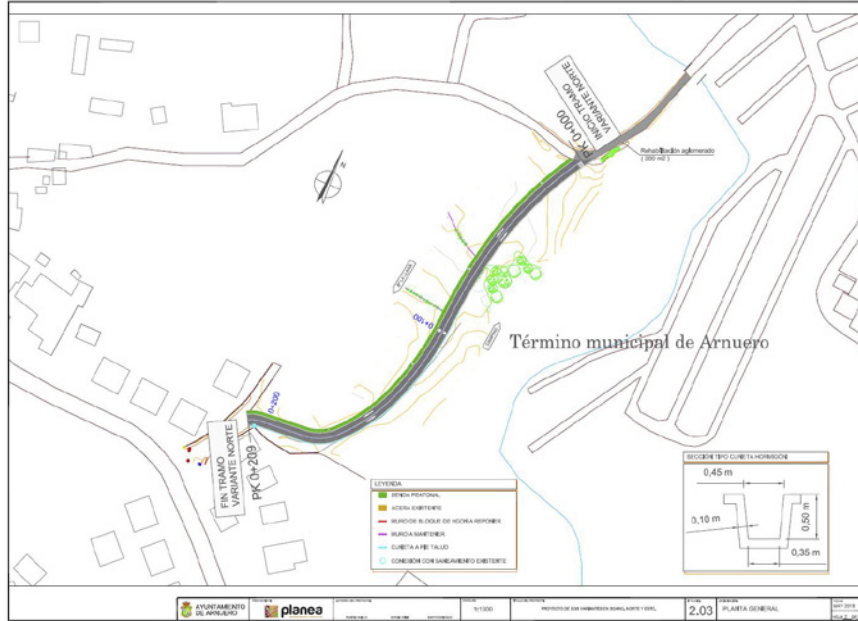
Plano de PLANTA GENERAL de la variante norte de Soano. Proyecto de Ejecución de dos variantes al este y al norte de Soano.
